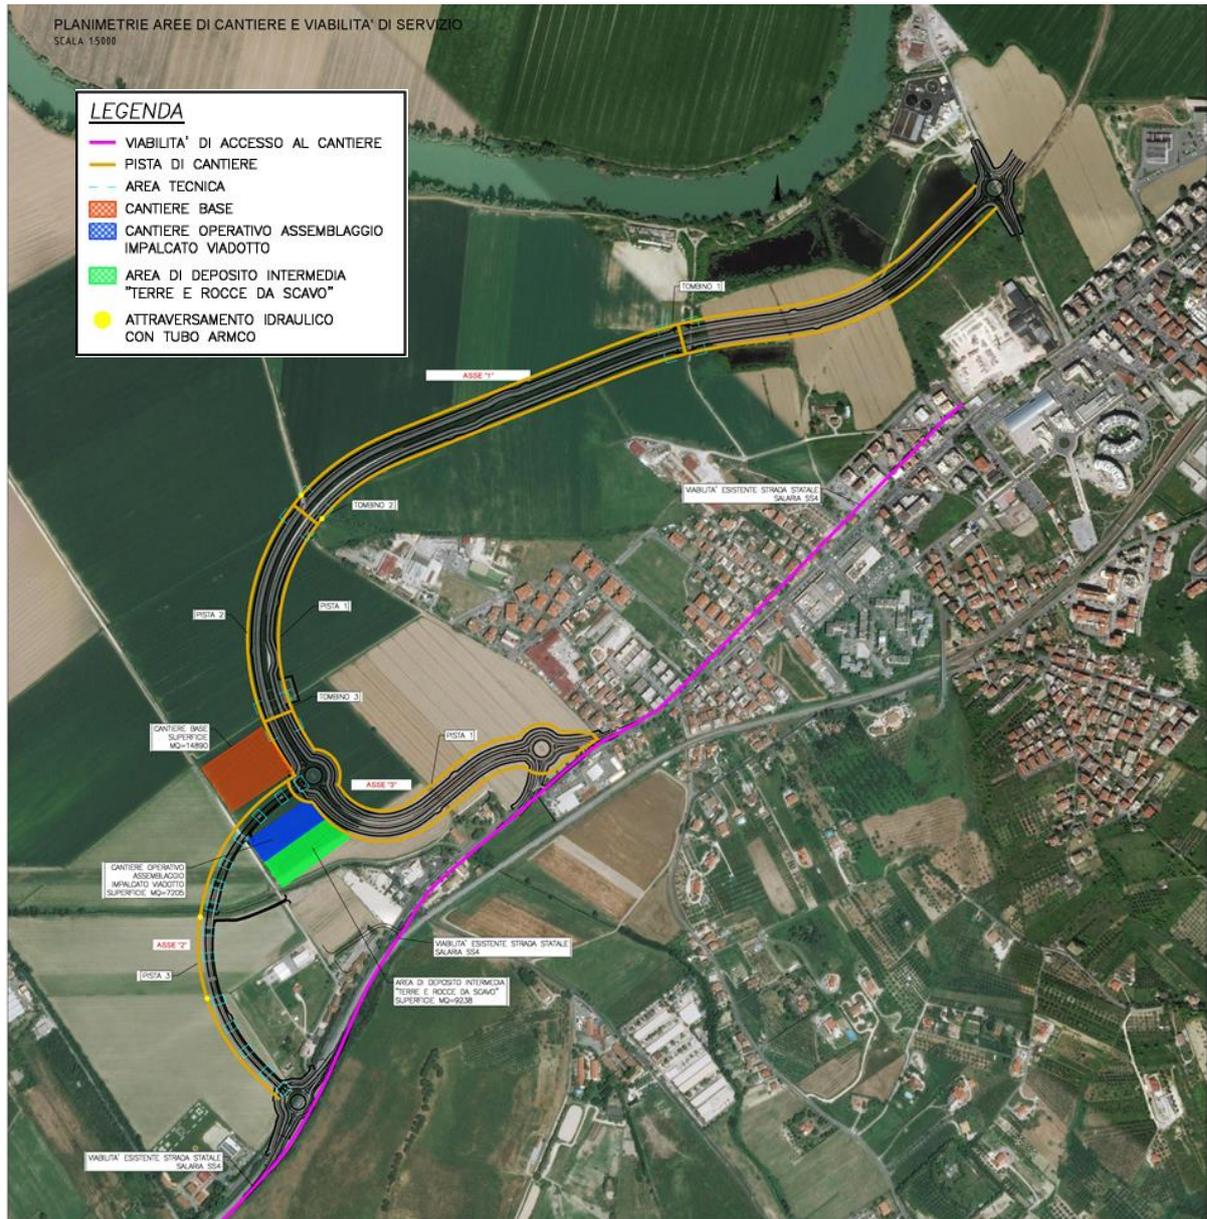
Planimetria aree di cantiere e viabilità di servizio – traffici (T00-CA00-CAN-PL01)
